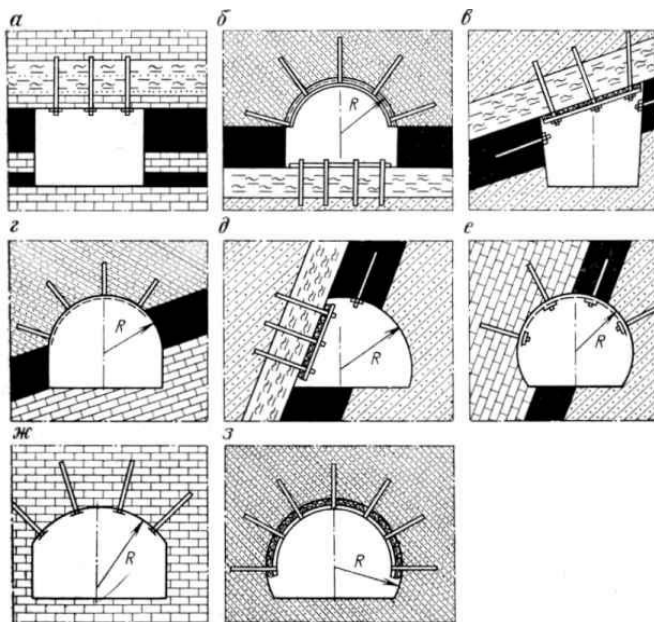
Схеми кріплення виробок штангами: а, ж – з опорними плітками; б, д – з прямолінійними підхопленнями з дерева або металу з дерев'яною затяжкою; б, в, г, з – з арковими стальними підхопленнями
